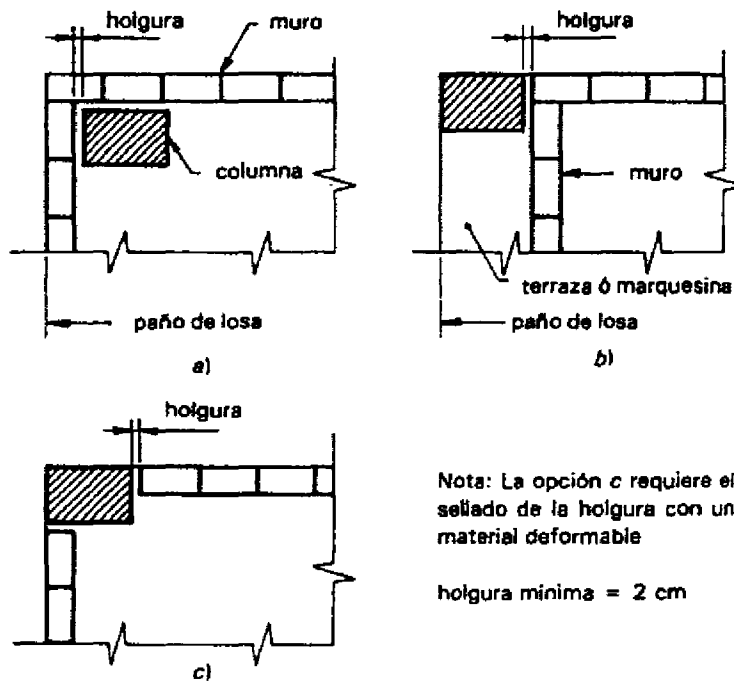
Posibles Disposiciones de Muros en Planta para Desligarlos de la Estructura
